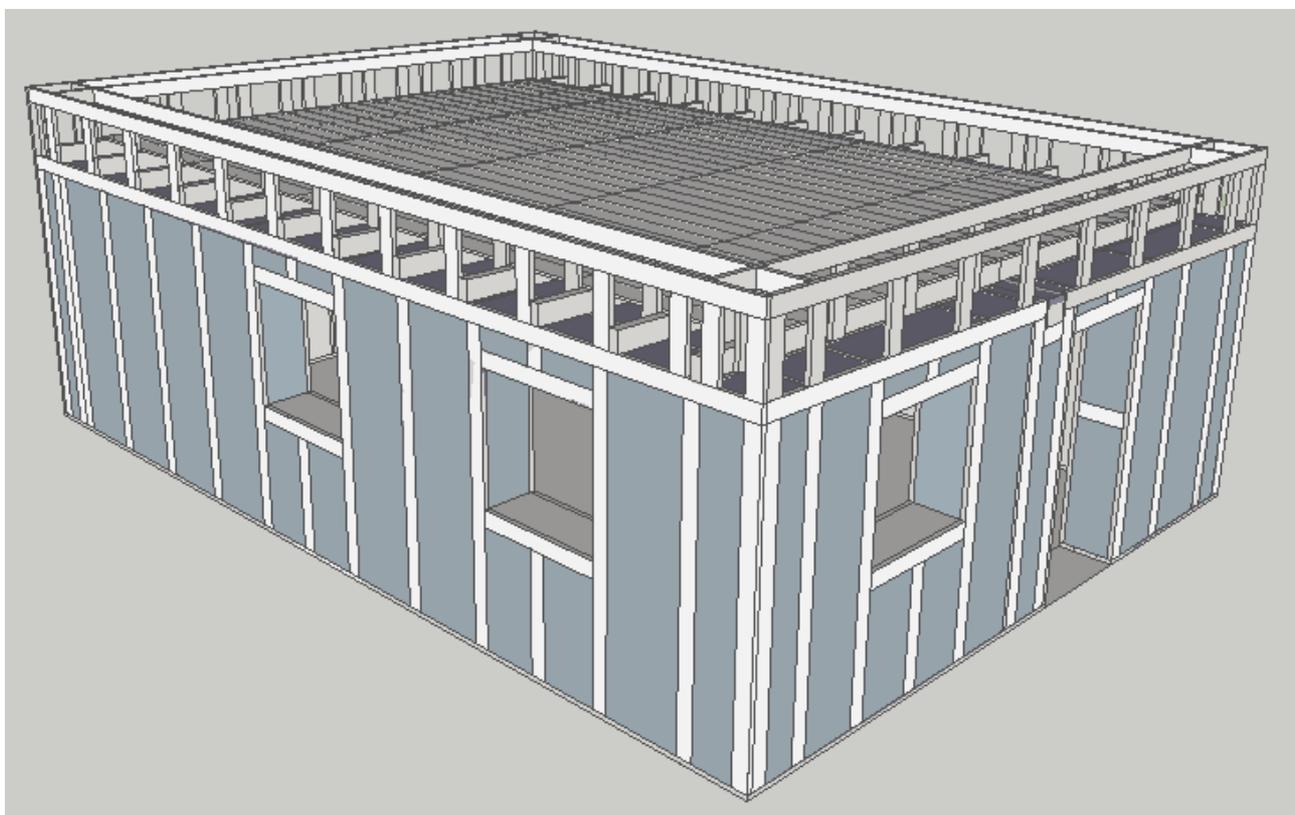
Ossature en bois des murs de la toiture et plancher reposant sur les solives.
